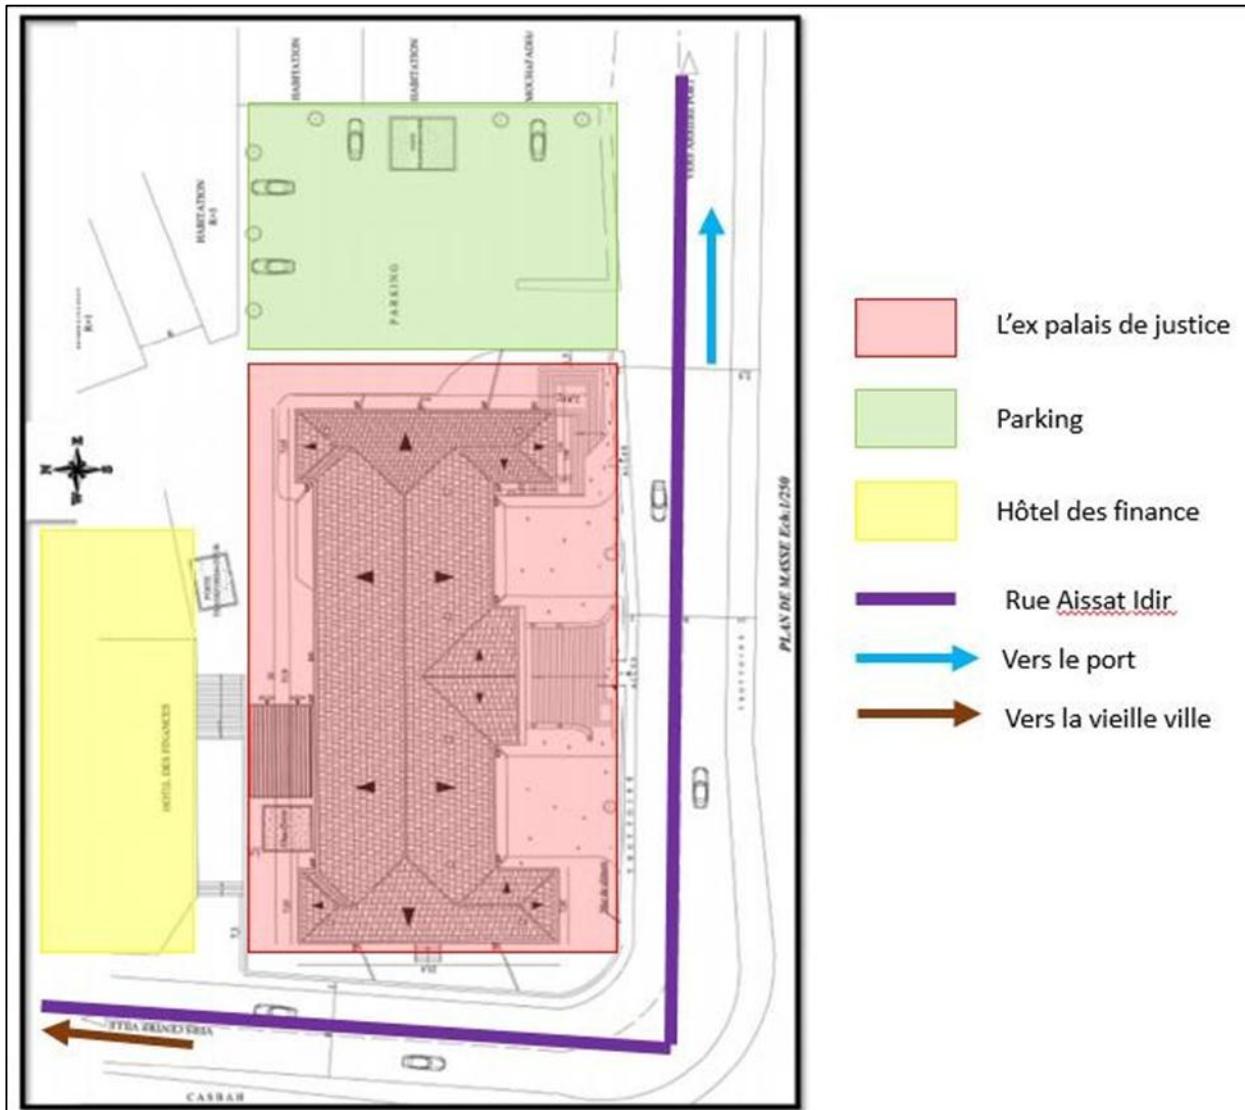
Plan de masse du conservatoire musical de Bejaia. (Fond : relevé de la direction de la culture. Traitement : auteur 2025.)
